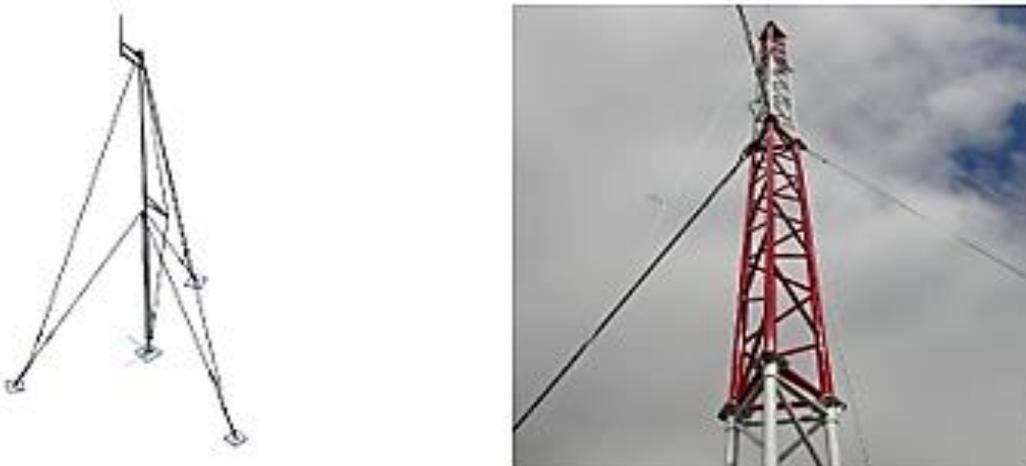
Типы мачт: слева – трубная; справа – ферменная конструкция
